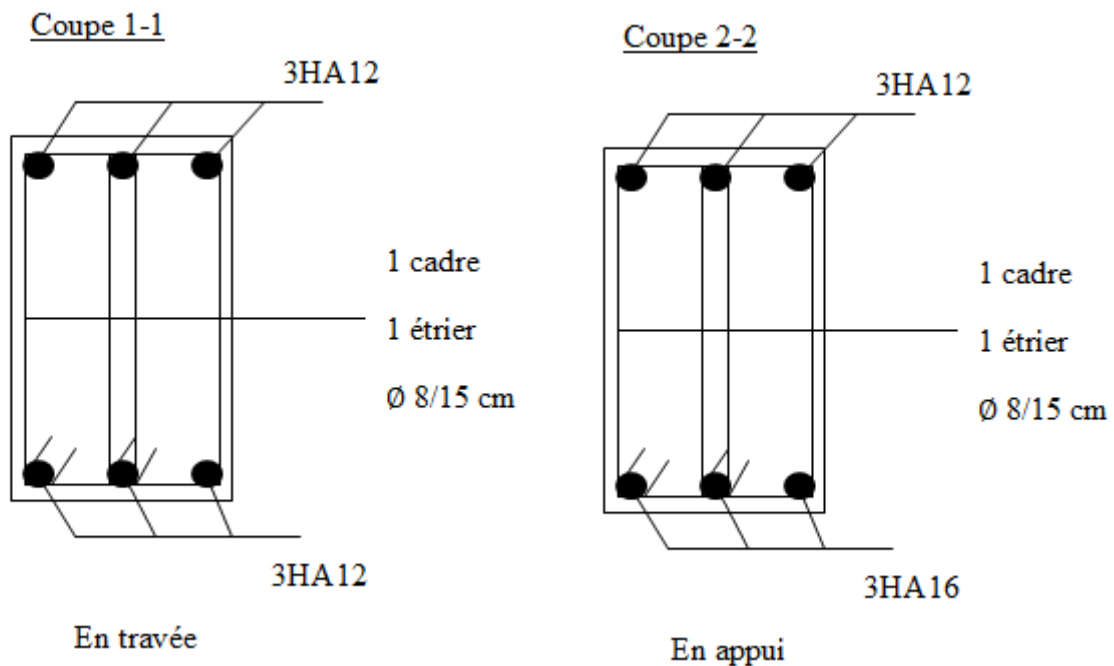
schéma de ferrailage transversal des poutres principales.
